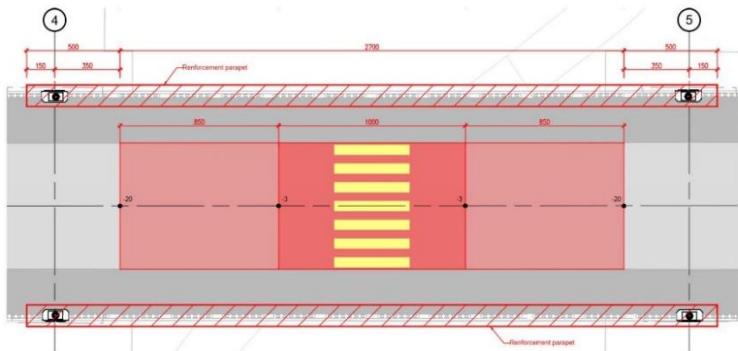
Plan und technische Schnittzeichnung des Übergangs auf der Brücke
